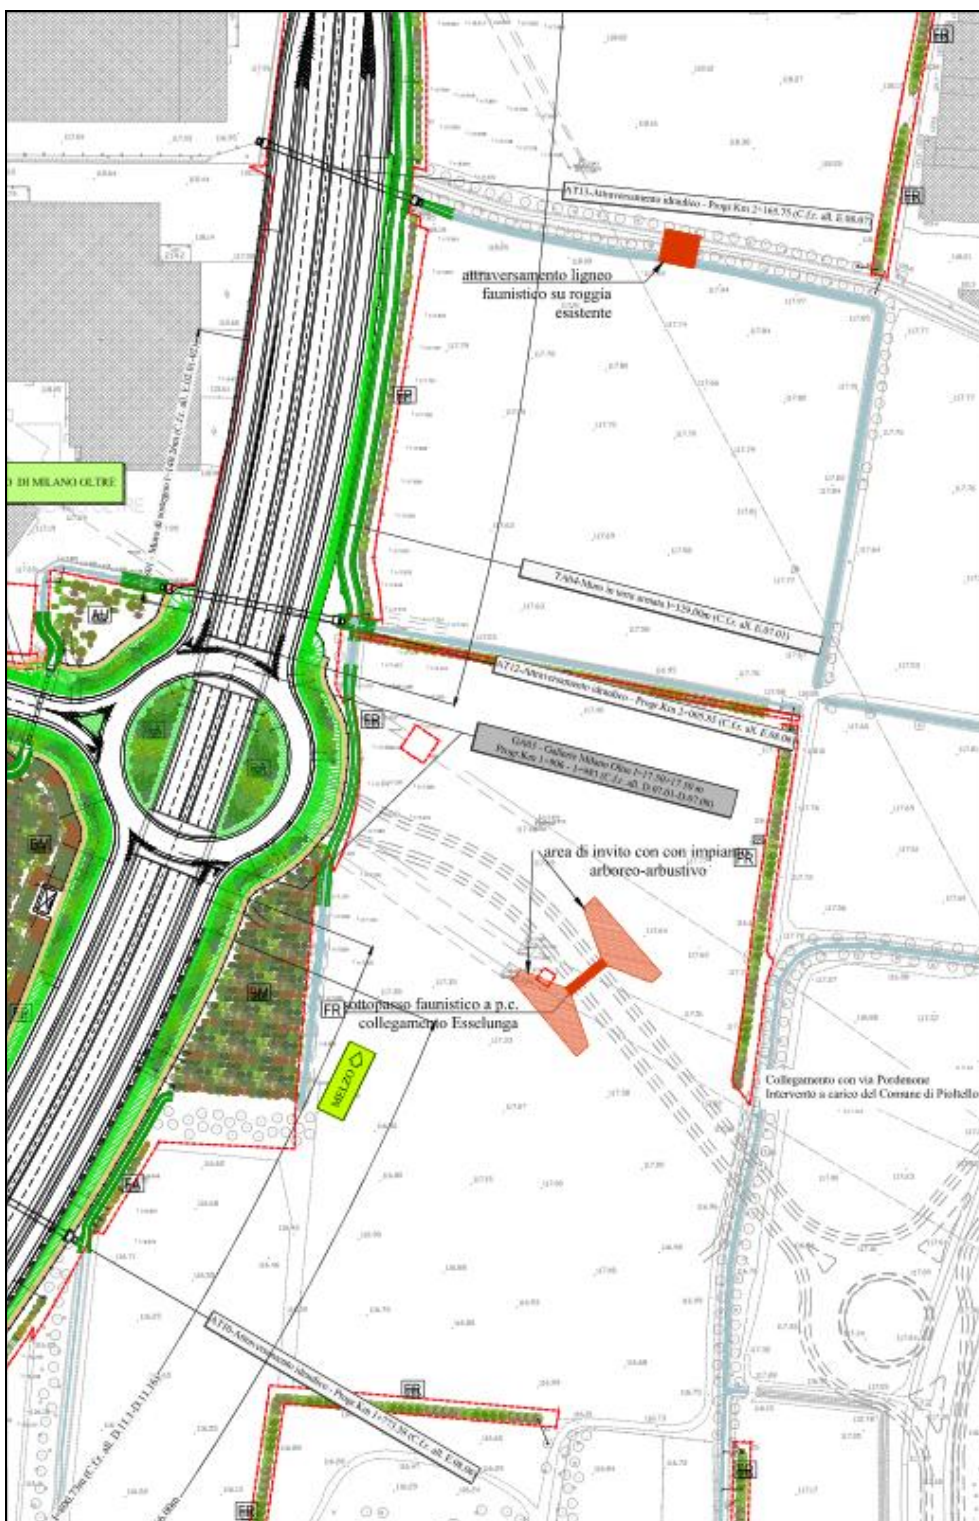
Schema planimetrico del sovrappasso faunistico del tracciato infrastrutturale Track B (Fonte: ERREVIA srl)
